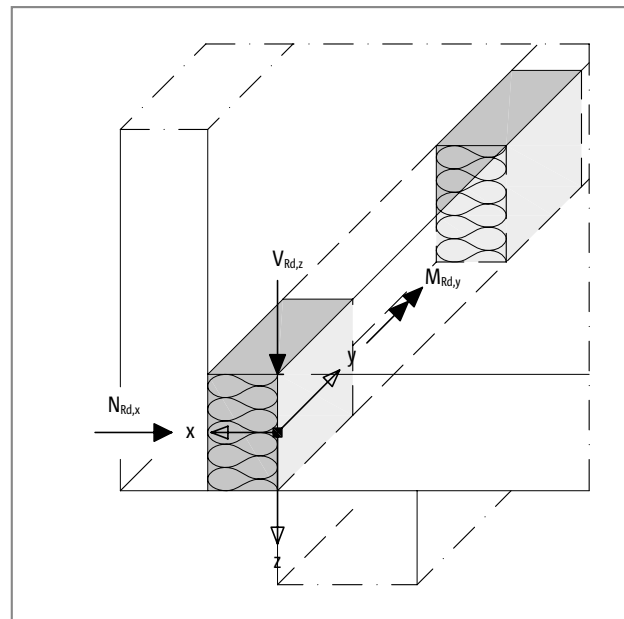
Schöck Isokorb® tipo ABXT, regola dei segni per il calcolo dei parapetti anteposti
